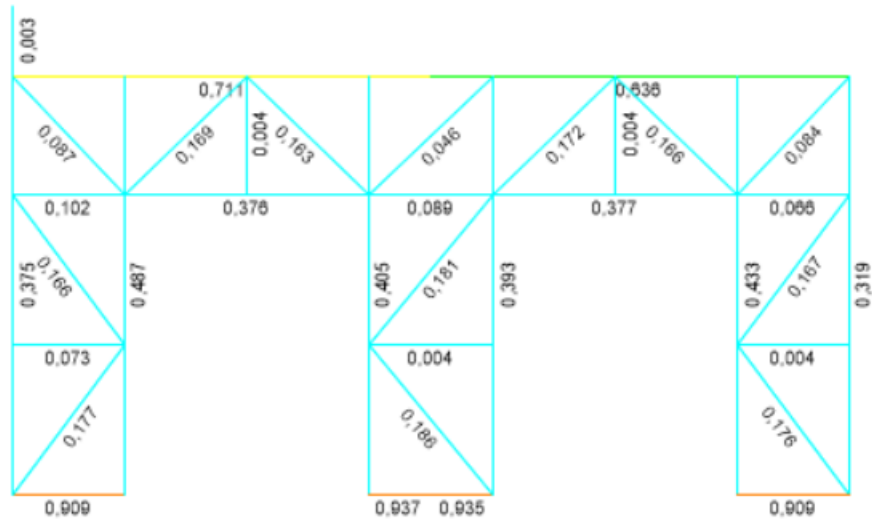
Factores de utilización vista en planta elevación 13.3 m.
